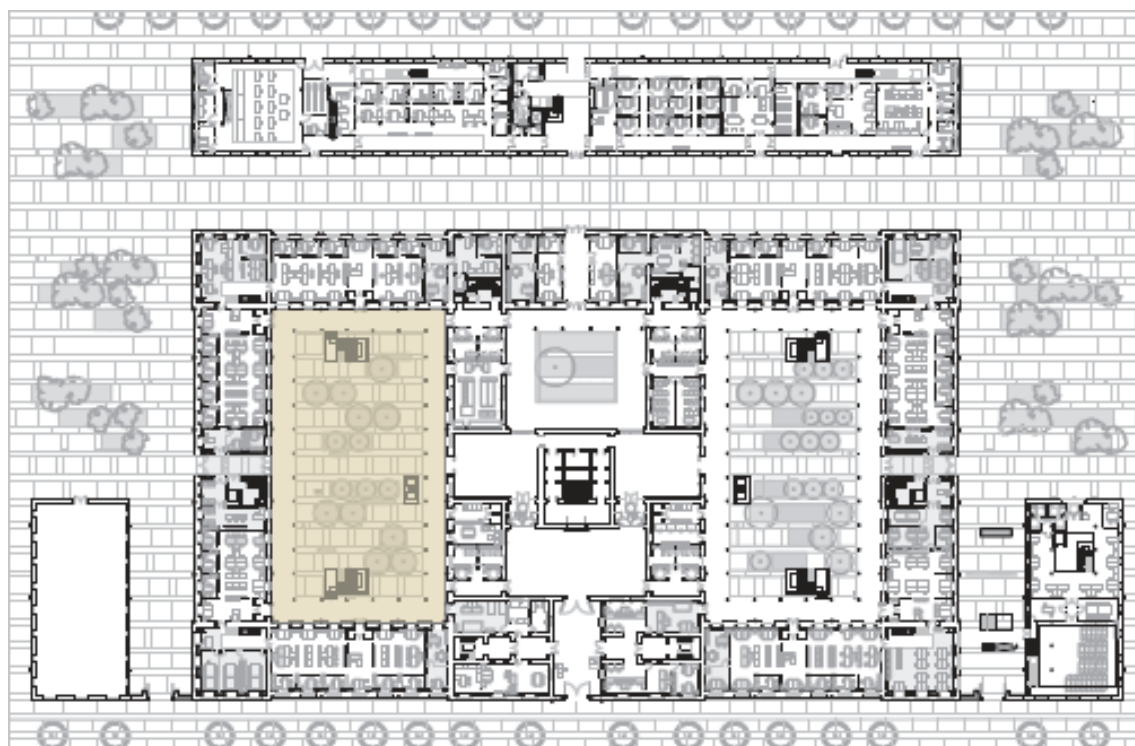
Planta de distribución del conjunto con la propuesta de intervención en uno de los patios
